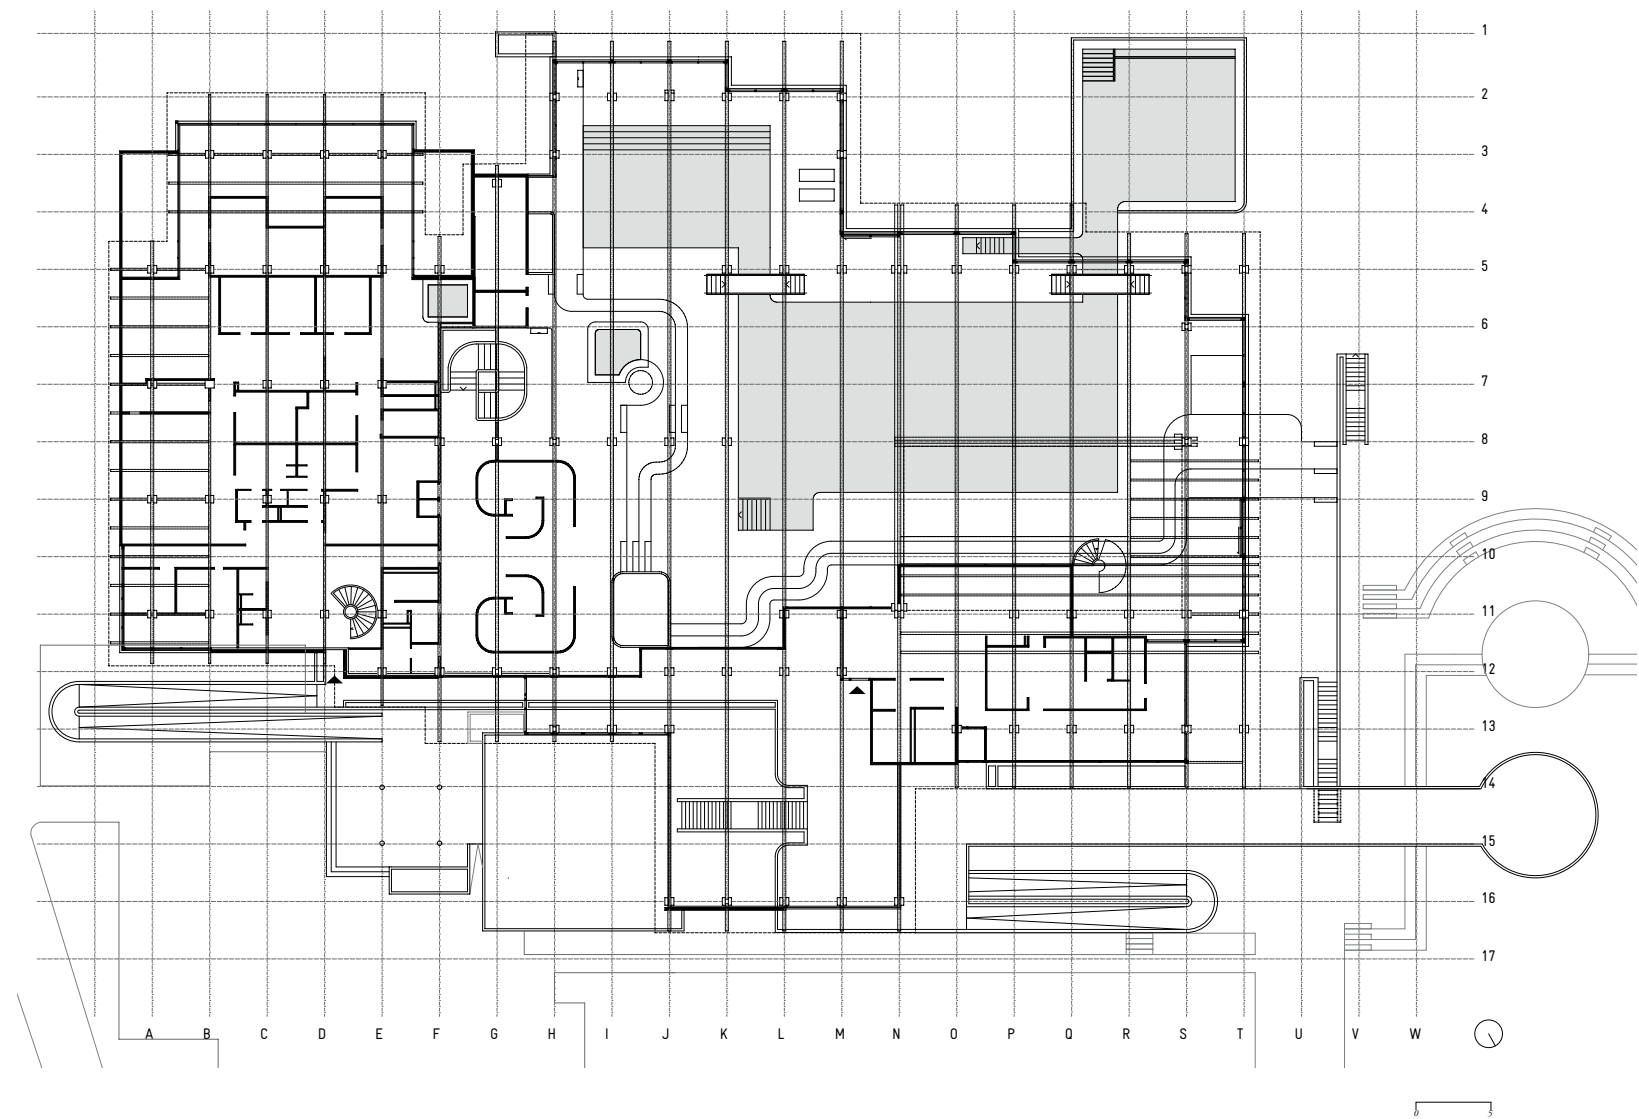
Grundriss Obergeschoß, 1:500, rekonstruiert
